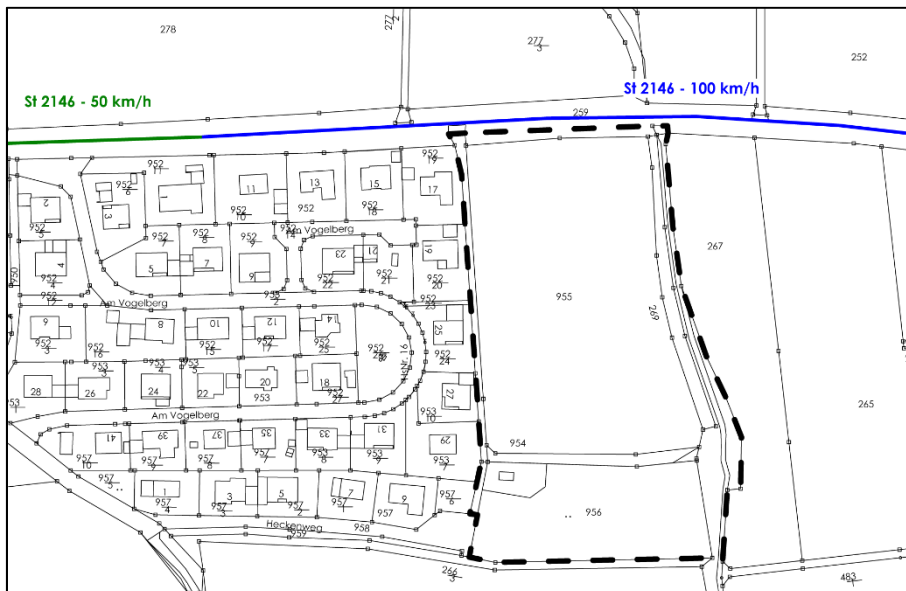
Lageplan mit Eintragung der Staatsstraße St 2146
